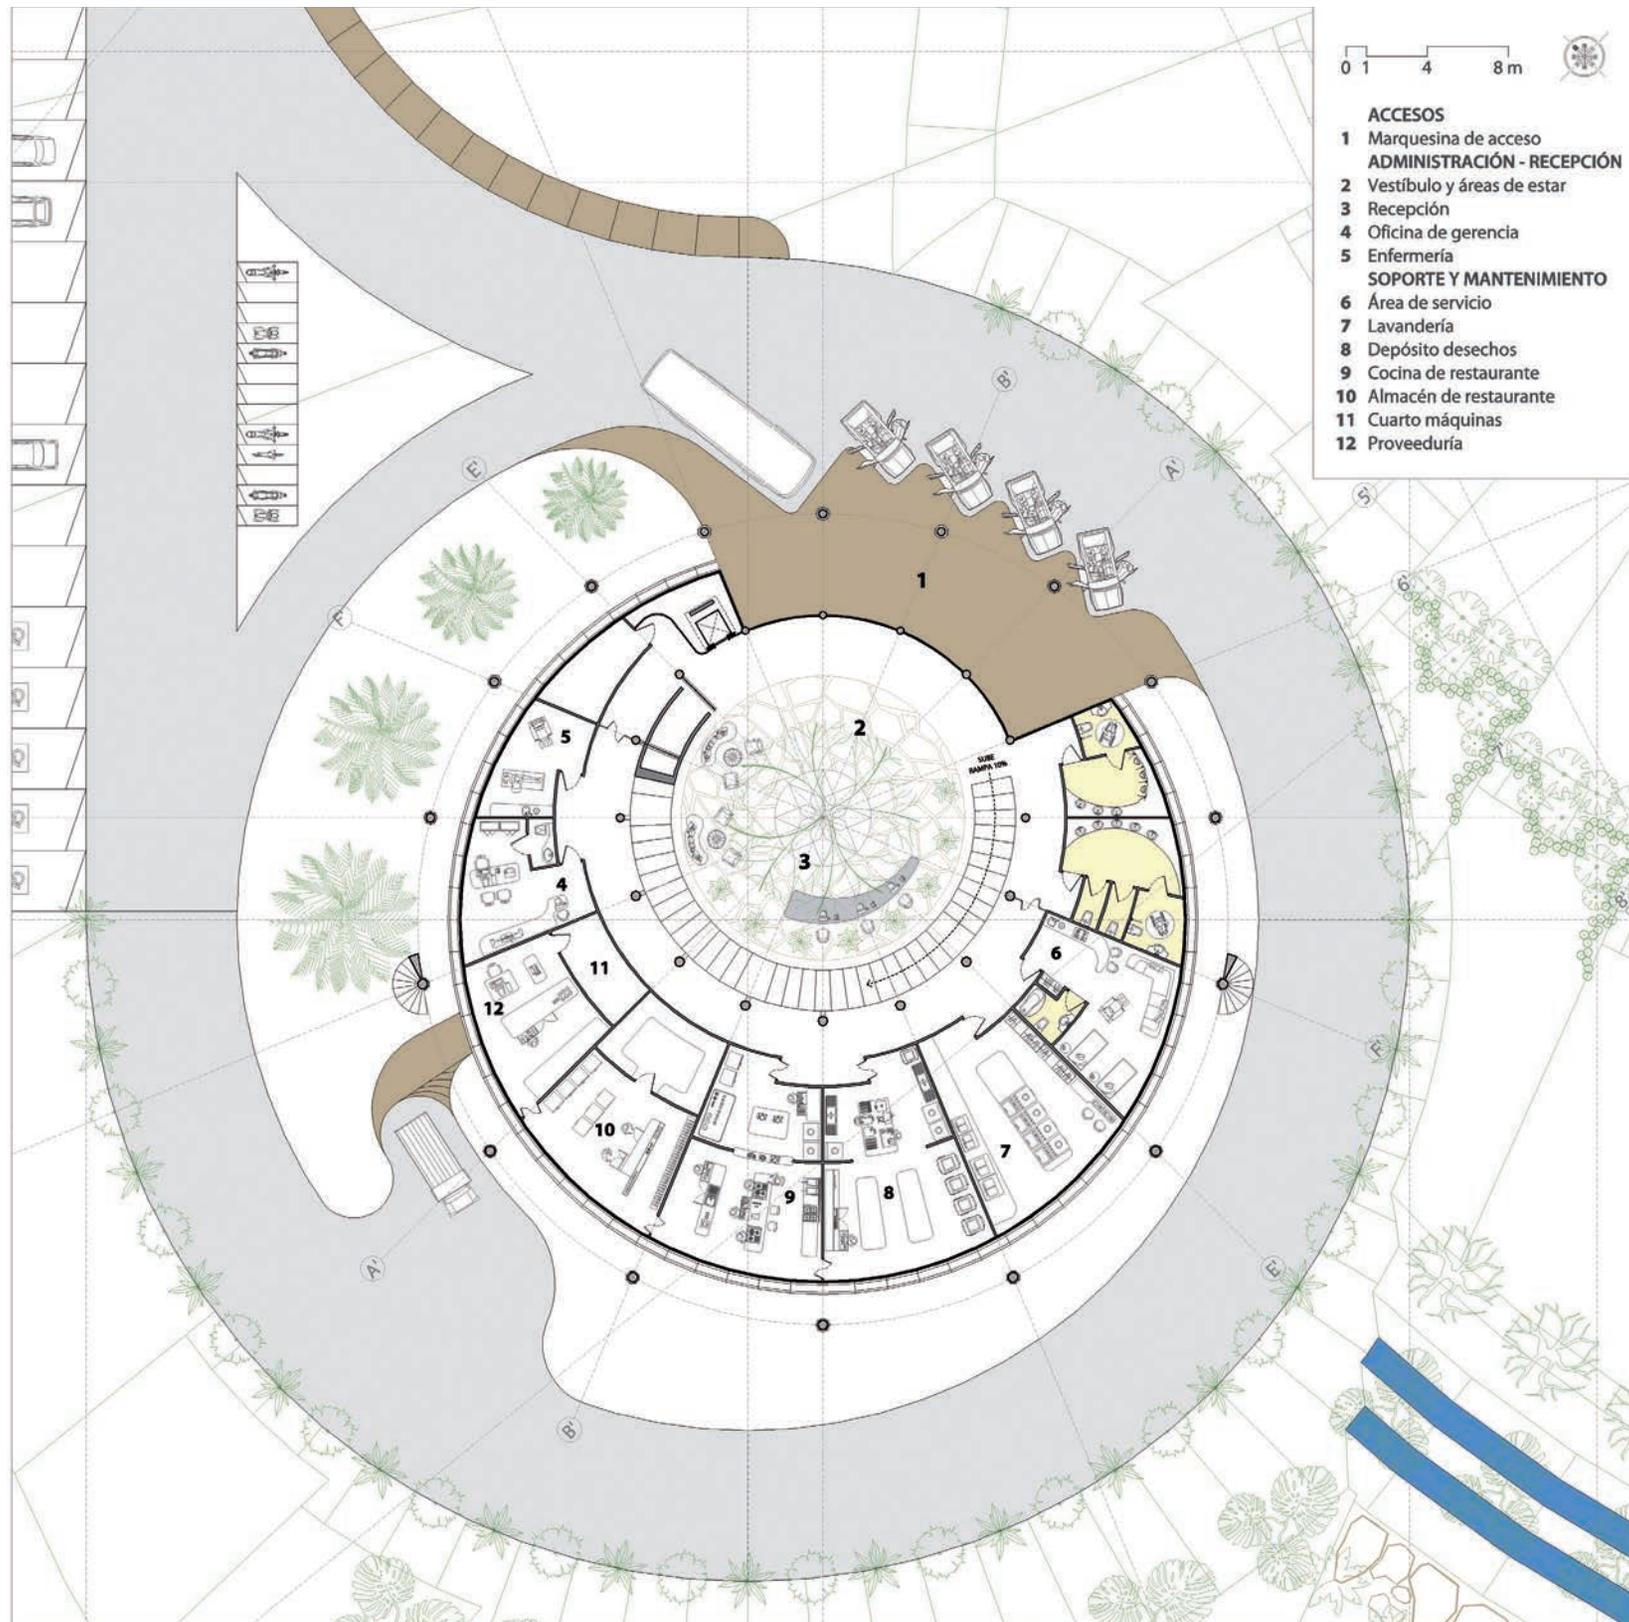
Planta Arquitectónica de la Administración y la Recepción, Nivel 1, 0+0,00 m snpt.
